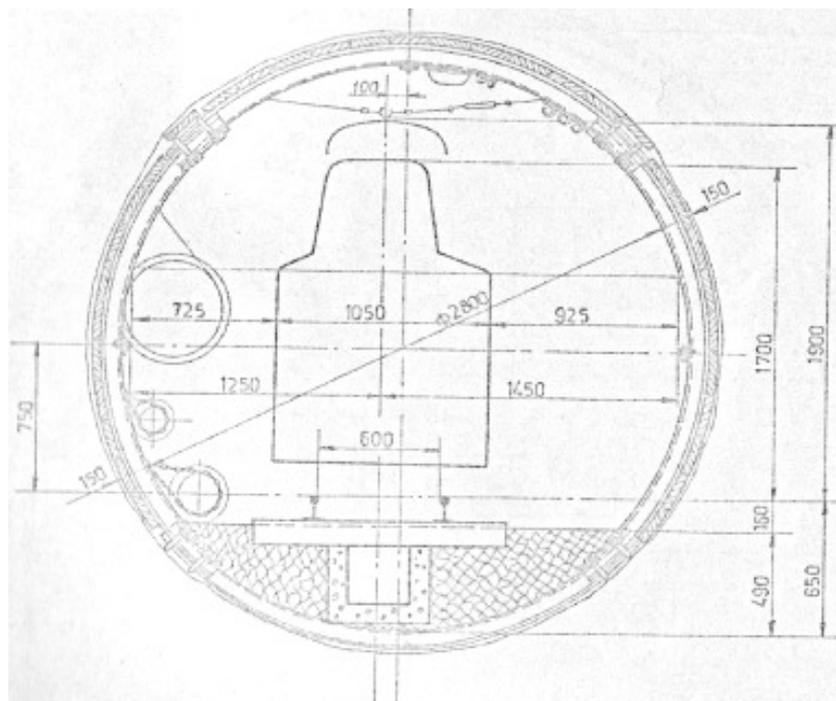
Stollen mit einer Sicherung aus Metallrahmen(Ringen) – eingleisige gerade Strecke
